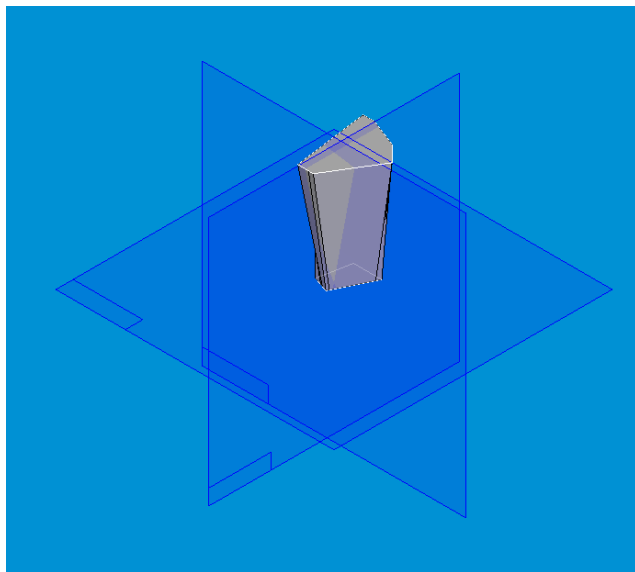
Ricostruzione geometrica del pilastro 24.
